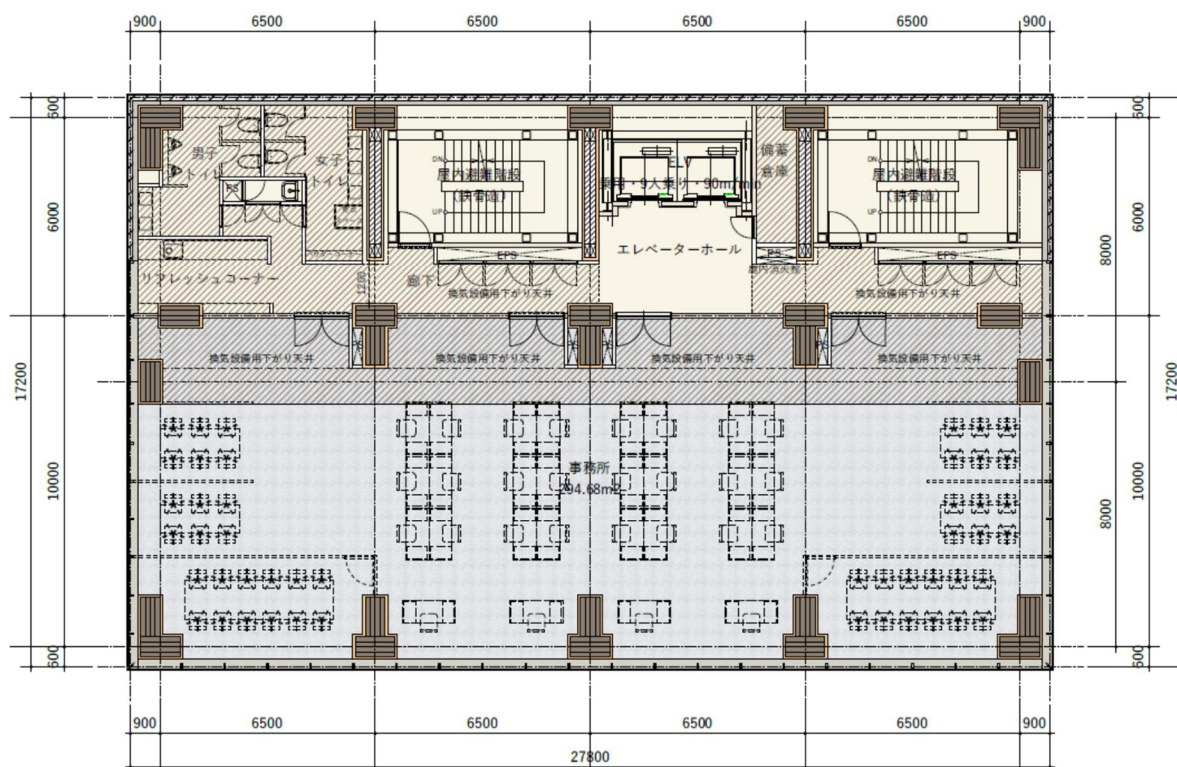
集成材フレーム構造による多層事務所建築物の構造設計例における基準階平面図
